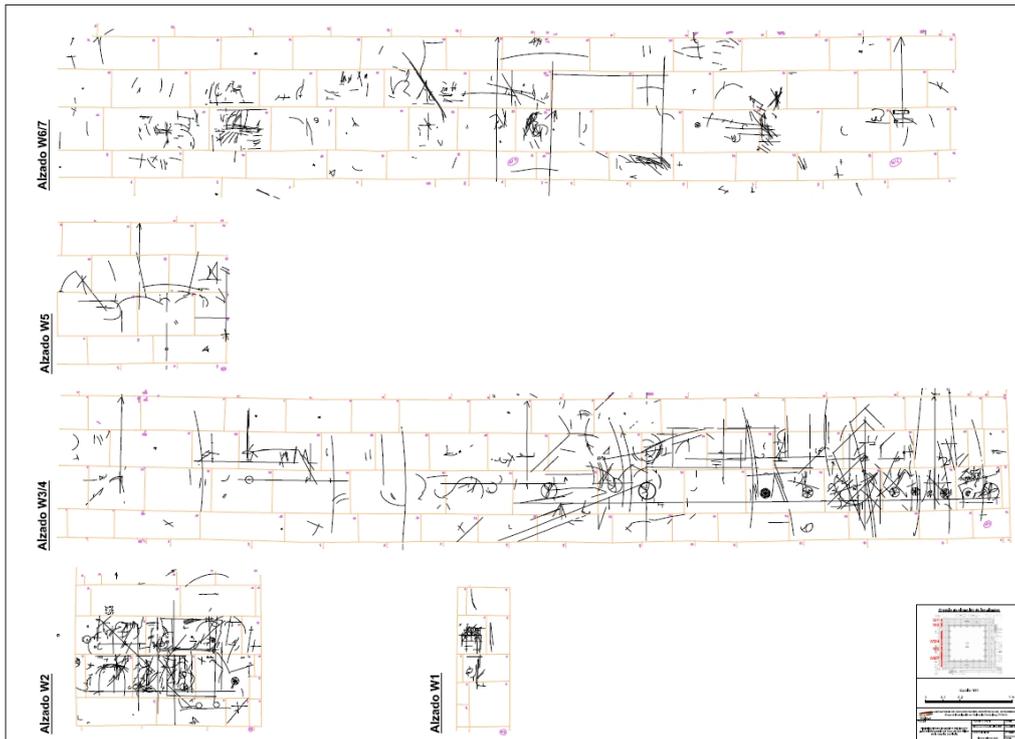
Vista general del plano correspondiente a los paneles del alzado oeste.
